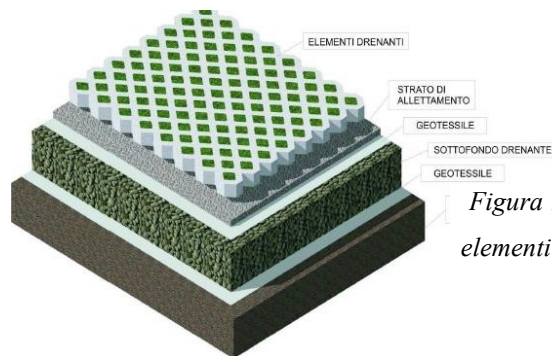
Schema di pavimentazione drenante con elementi costitutivi. (Fonte: <https://www.infobuild.it/>)
